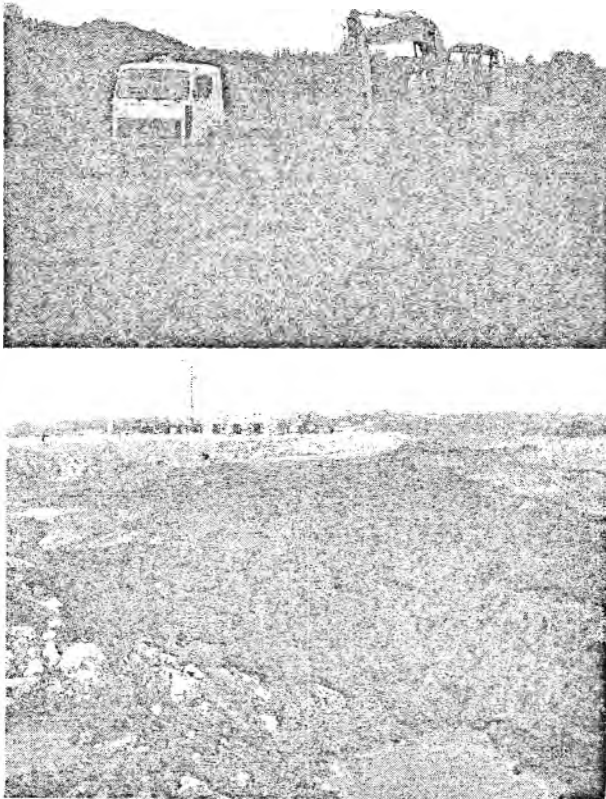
Локальное удаление техногенных отложений и начало строительства
